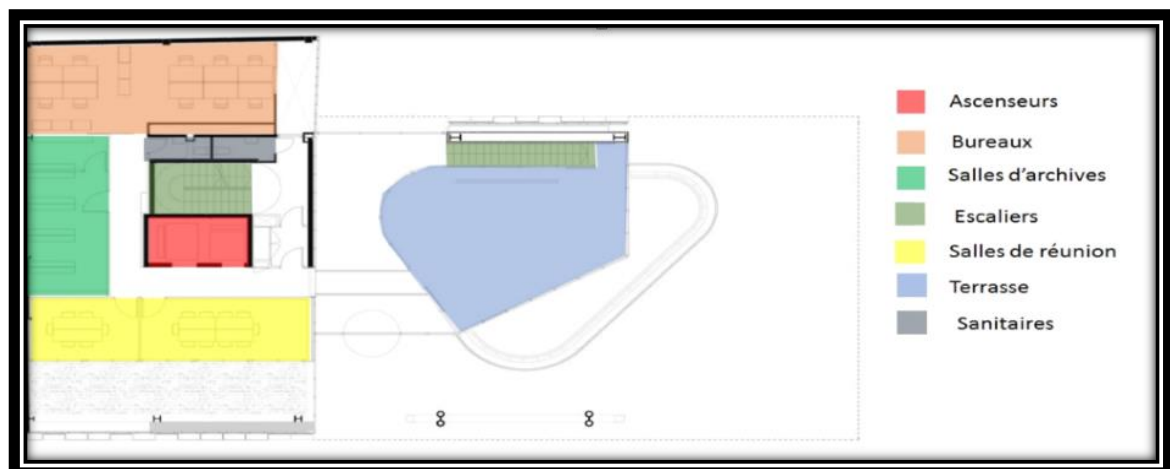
plan du 1^{er} étage du centre, source : Pintrest.
